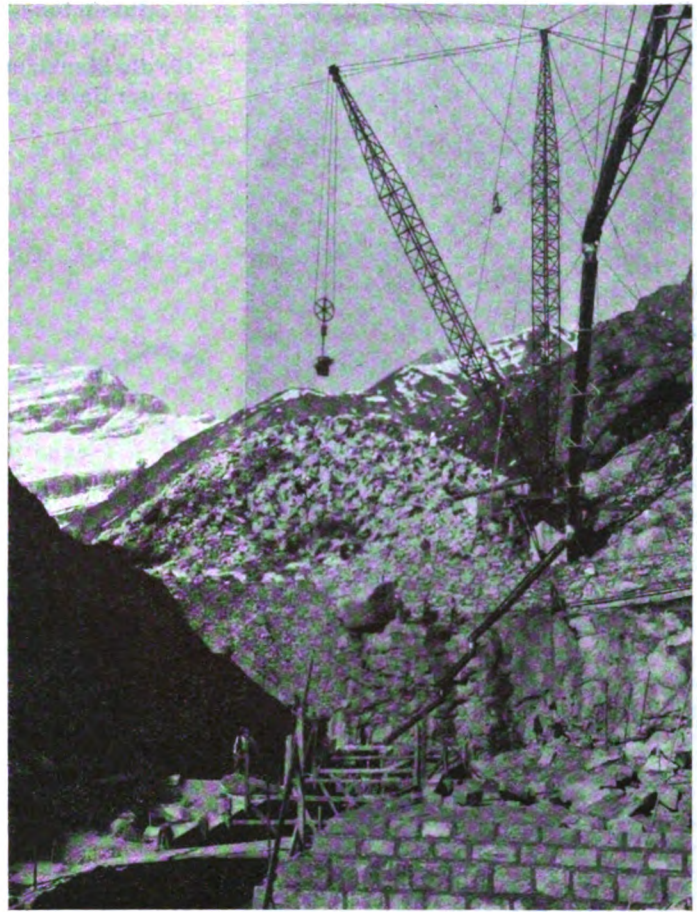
Derrick-Kran an der Staumauer-Baustelle.
